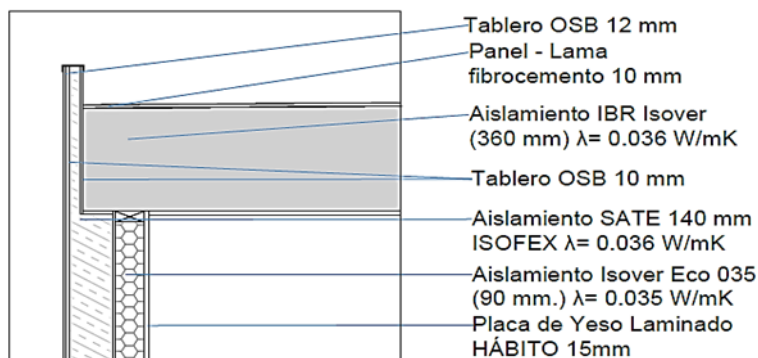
(a): Encuentro cubierta – fachada vivienda ABS.
